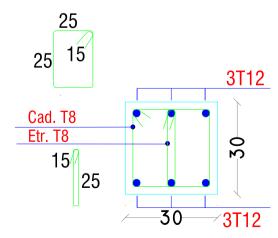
Ferraillage des poutres secondaire pour RDC, 1 ér Etage et 9 éme Etage.
